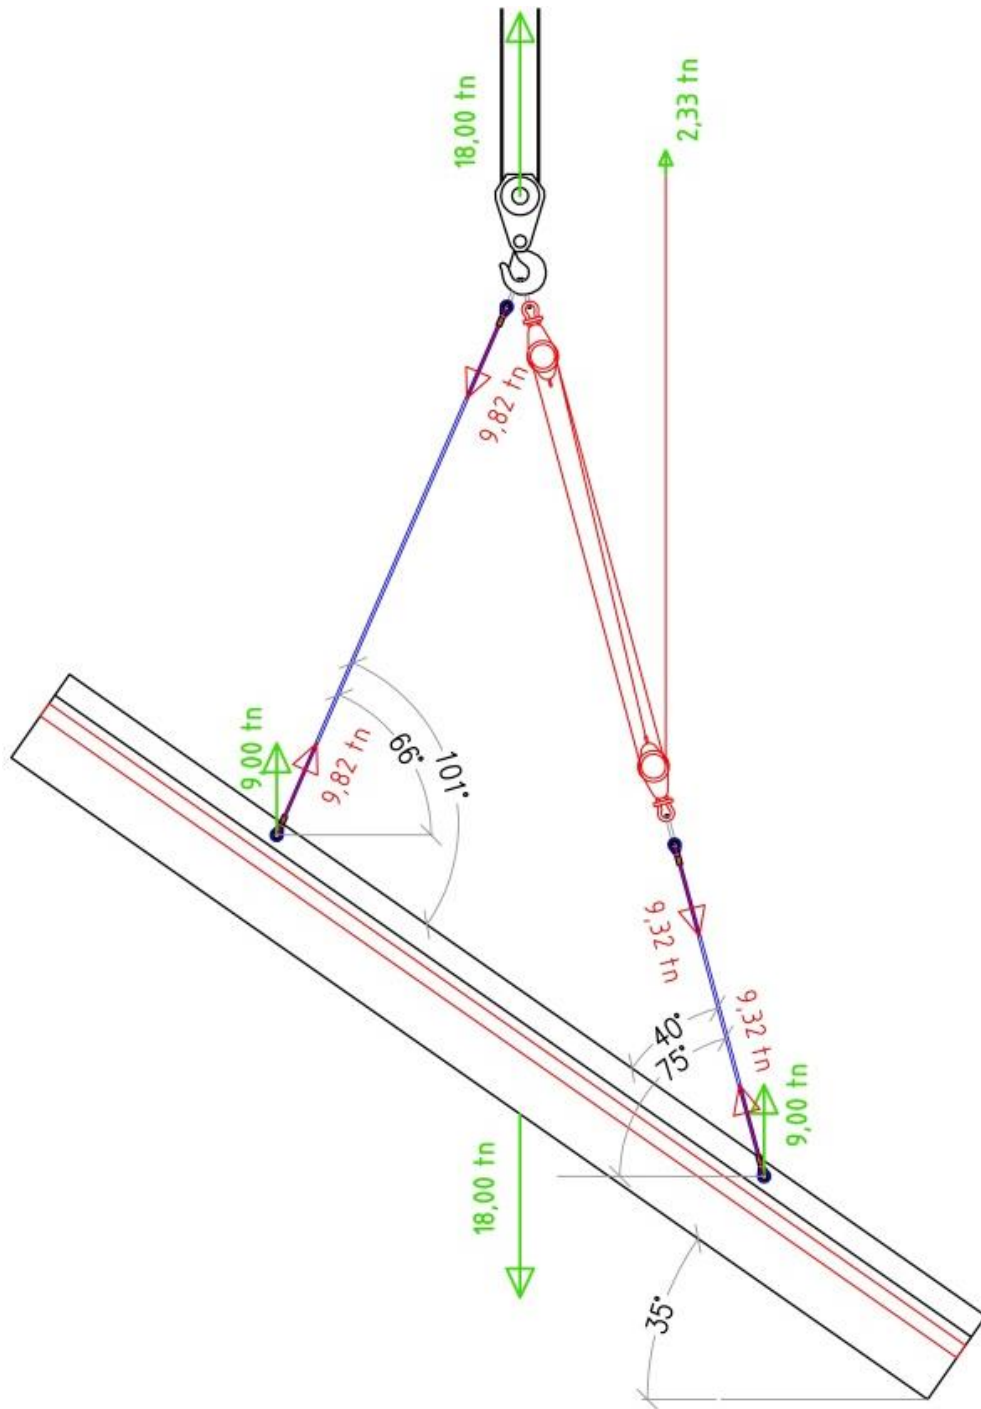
Elementos necesarios para el izaje y el giro de la viga – Posición a 35°
